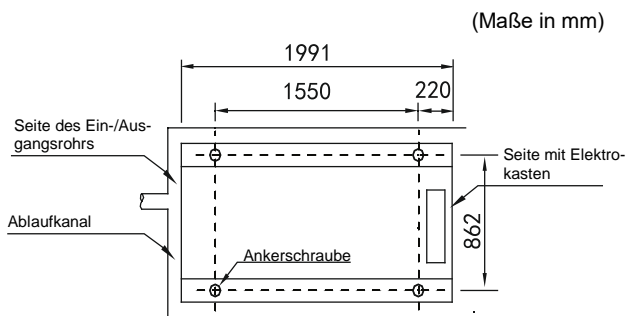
Skizze der Installationsmaße für SCV-750EBH – Draufsicht
